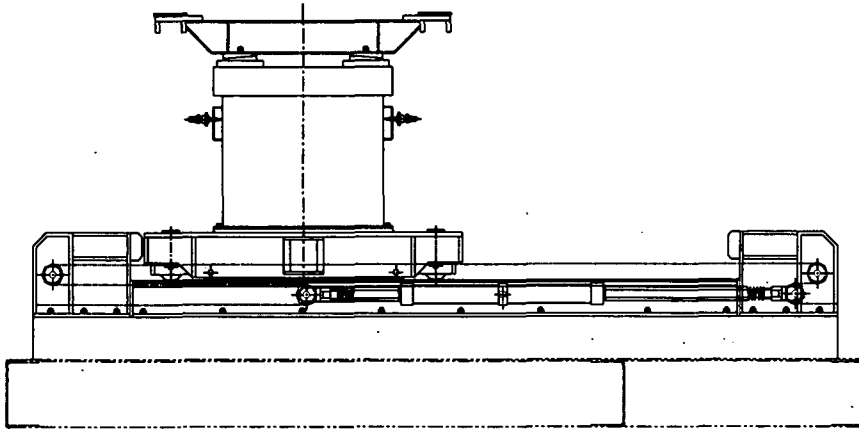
Girder 이송용 유압 실린더의 설치단면
